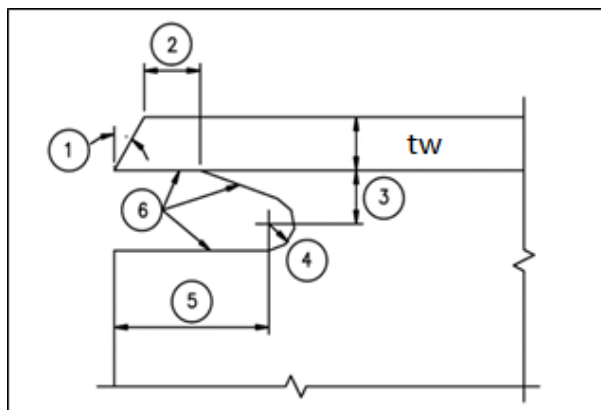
Detalle de Agujero de acceso para soldadura en zonas sísmicas
